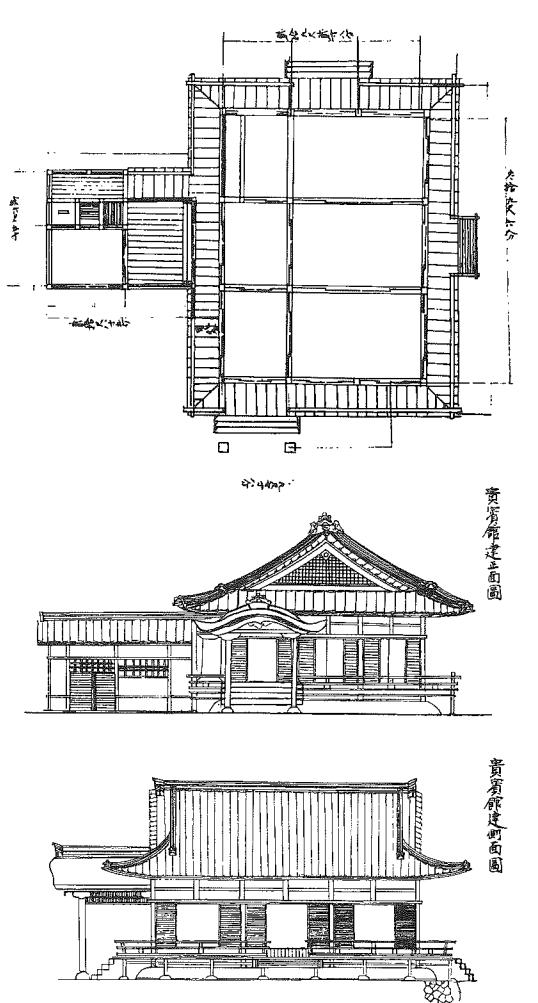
尚美館 平面図、正面図、東側面図（大正3年）
